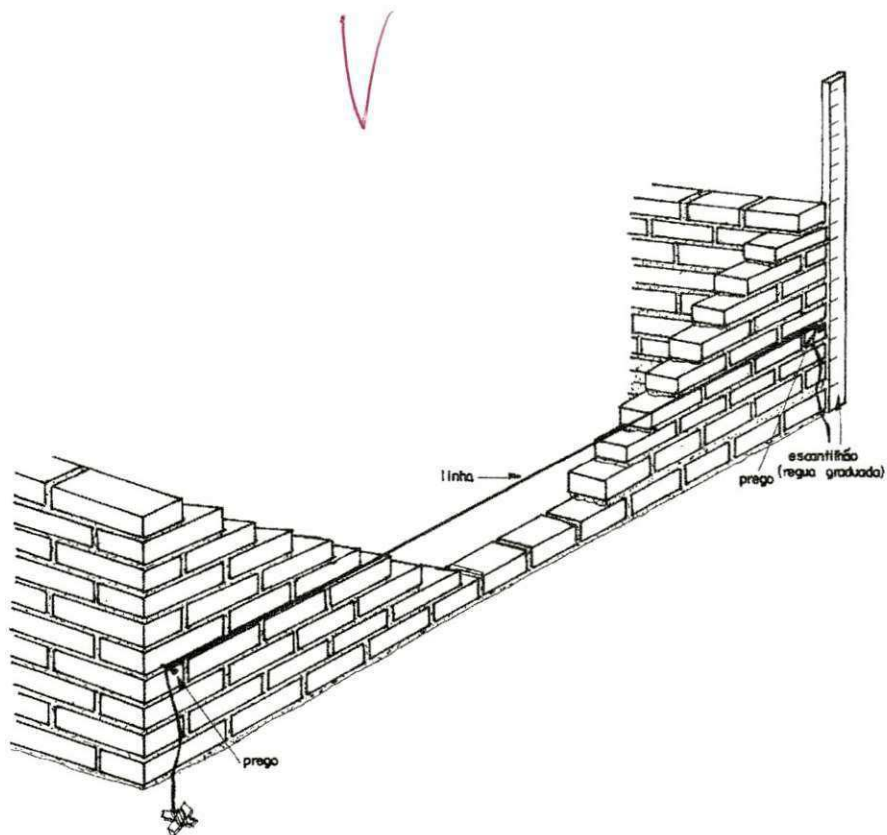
Detalhe do nivelamento da elevação da alvenaria
